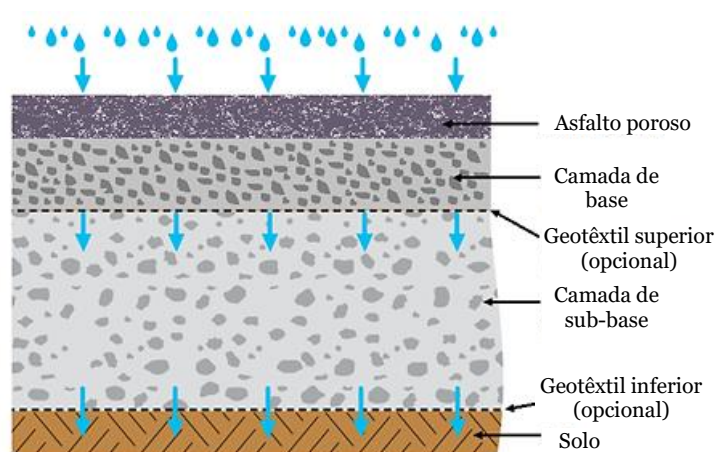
Perfil esquemático – infiltração total (Adaptado de Interpave, 2010)
